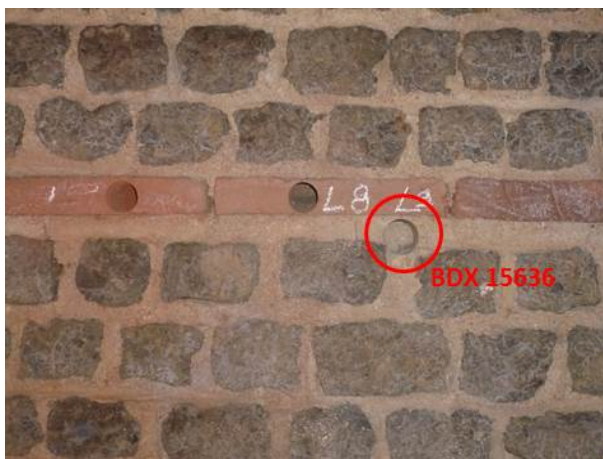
Détail du mur est dans la salle 10 avec la localisation du prélèvement BDX 15636.
